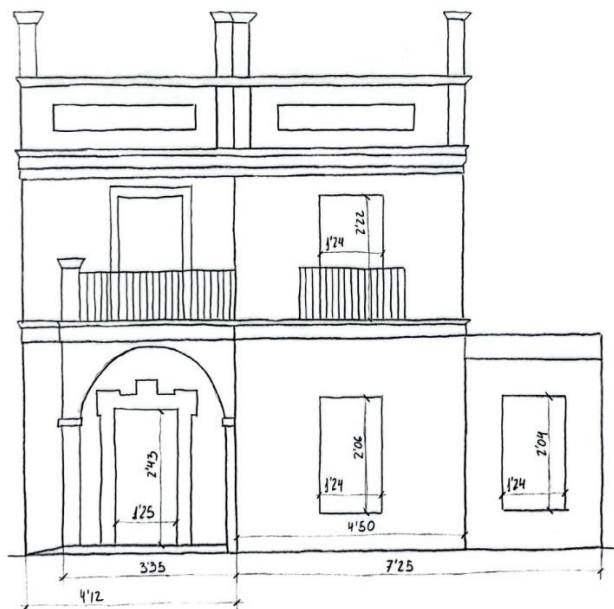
Croquis alzado principal (Fuente: Elaboración propia)
